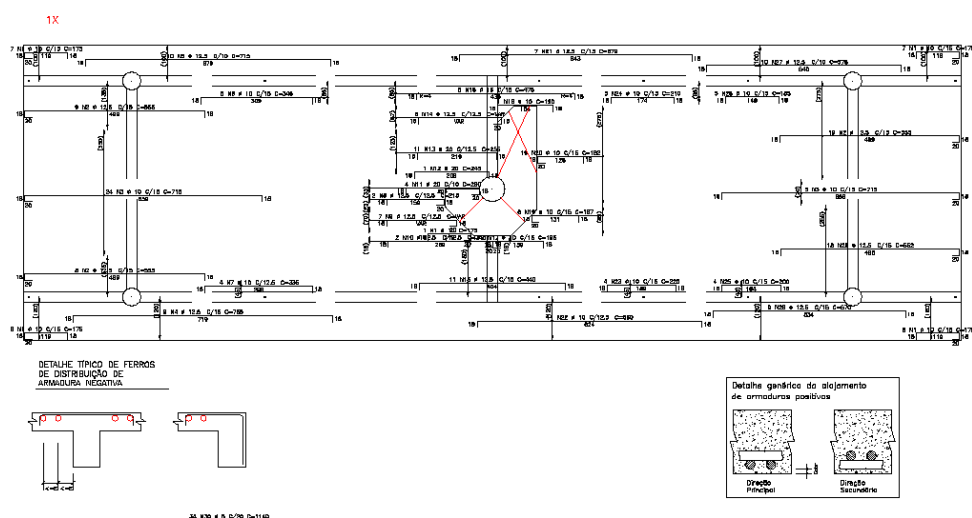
1º pavimento: armadura negativa principal. Fonte: AUTOR (2017).
